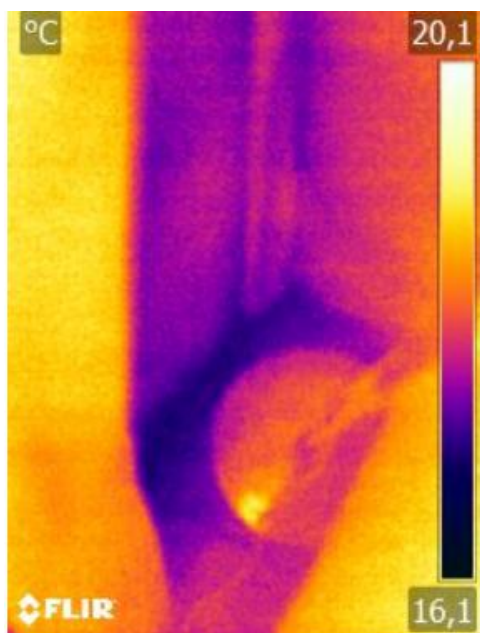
rez-de-chaussée, salon sur façade arrière
